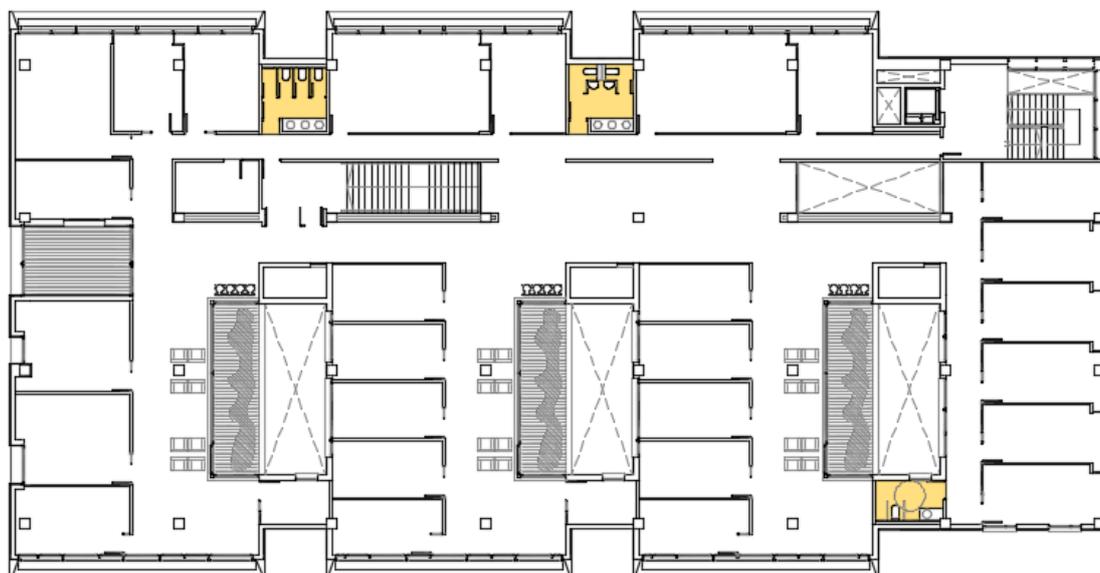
Situación Aseos en Planta Tercera. Figura extraída del plano 55.
